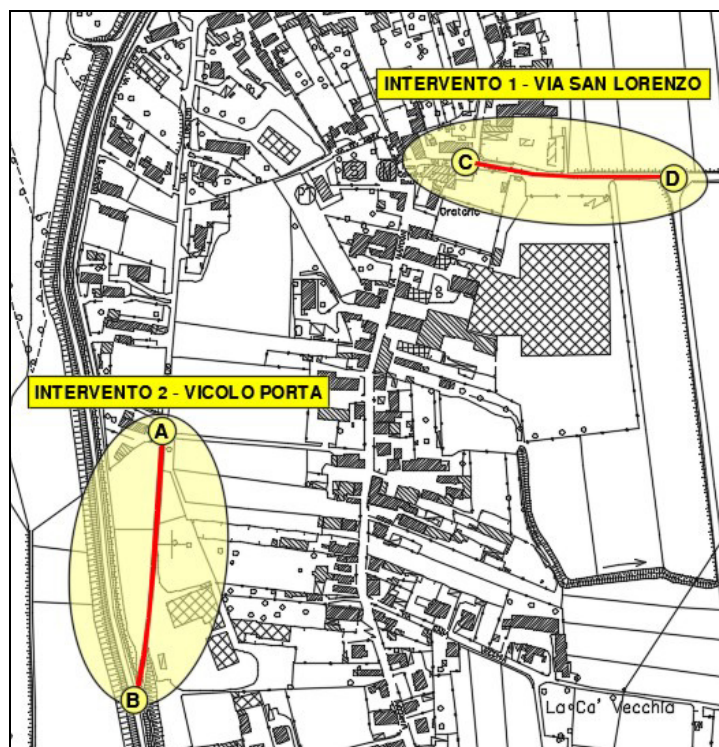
Pianta del centro abitato di Rea con individuazione degli interventi
